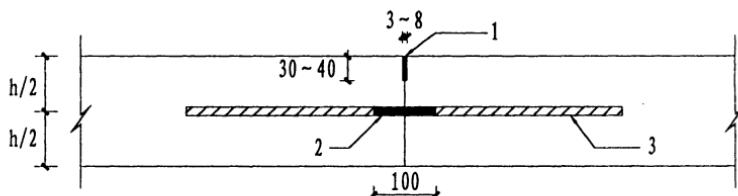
纵向施工缝构造(尺寸单位:mm)
